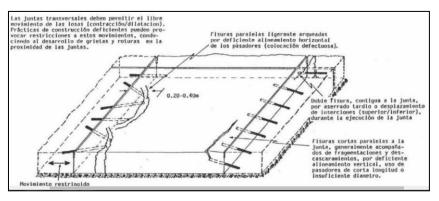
Falla por mal funcionamiento de juntas de Pavimento Rígido
